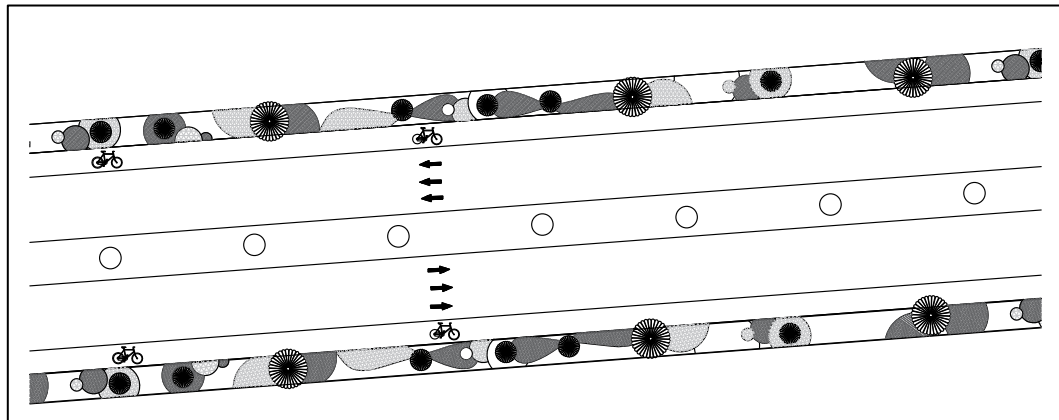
Planta del puente de acceso a la Ciudad Deportiva (2016)
